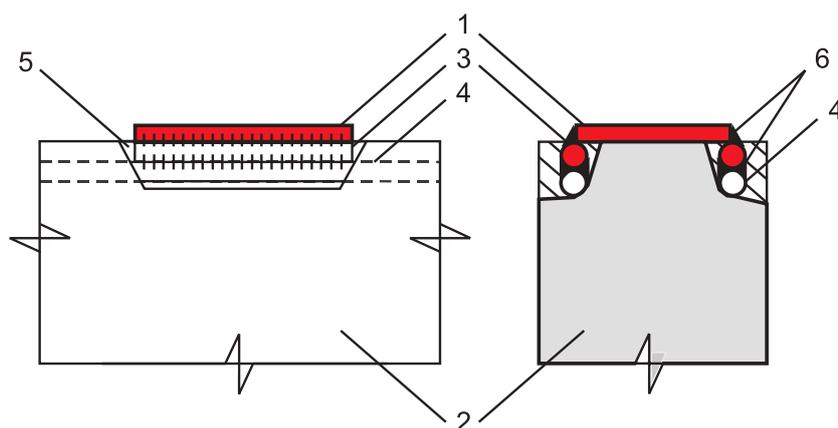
Схема приваривания закладной детали к армированию балки или колонны:
